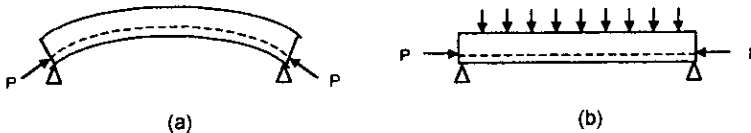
(a) Viga simplemente apoyada aplicando la fuerza presforzante en la parte inferior de la viga. (b) Viga simplemente apoyada, actuando la fuerza de presfuerzo y la cargas de servicio.
